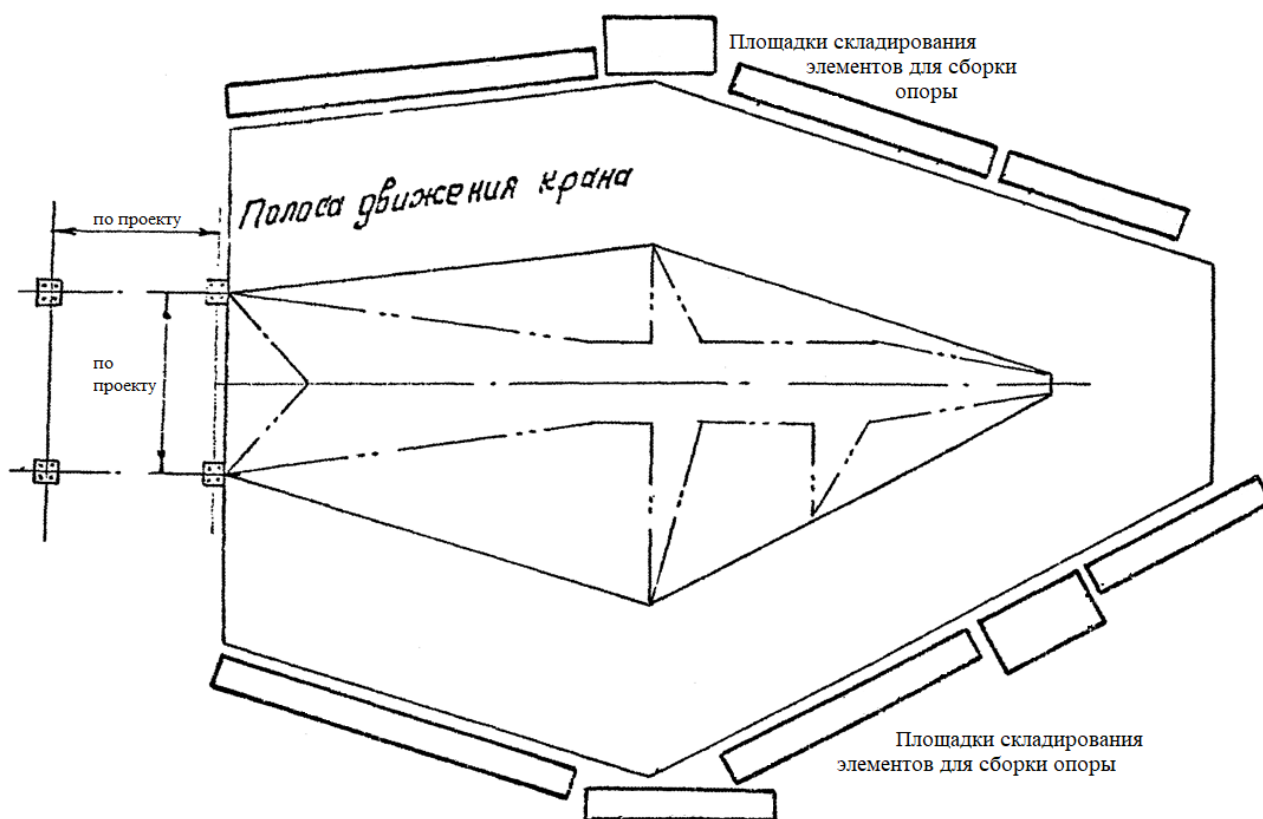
Схема раскладки пакетов с деталями для сборки решетчатых опор
